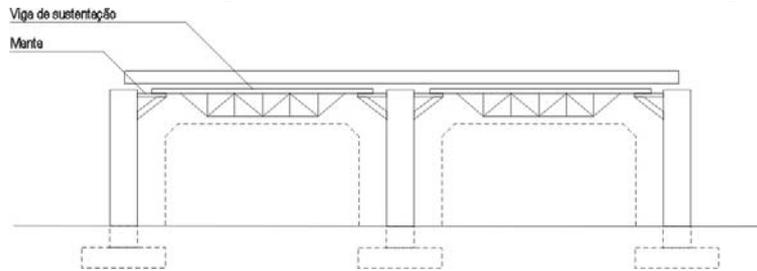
Método Construtivo da Viga Mestre de sustentação da estrutura celular em concreto protendido
